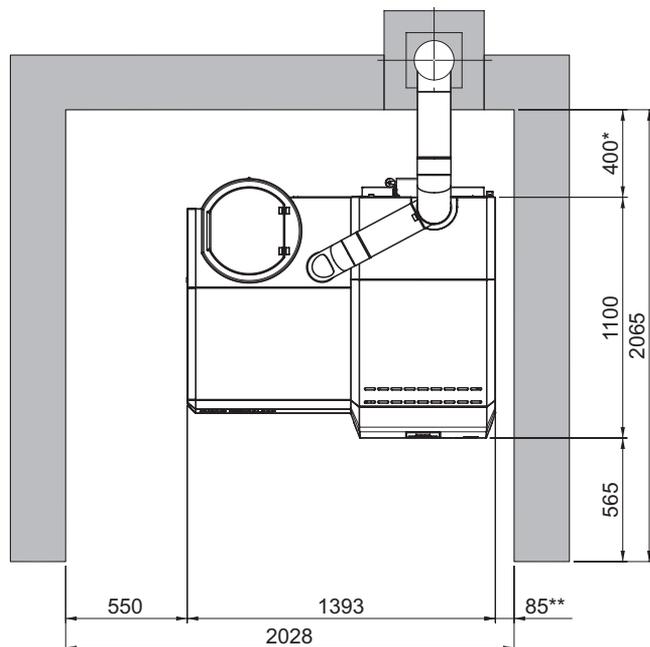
LogWIN Klassik pellet ready – Vue du dessus
